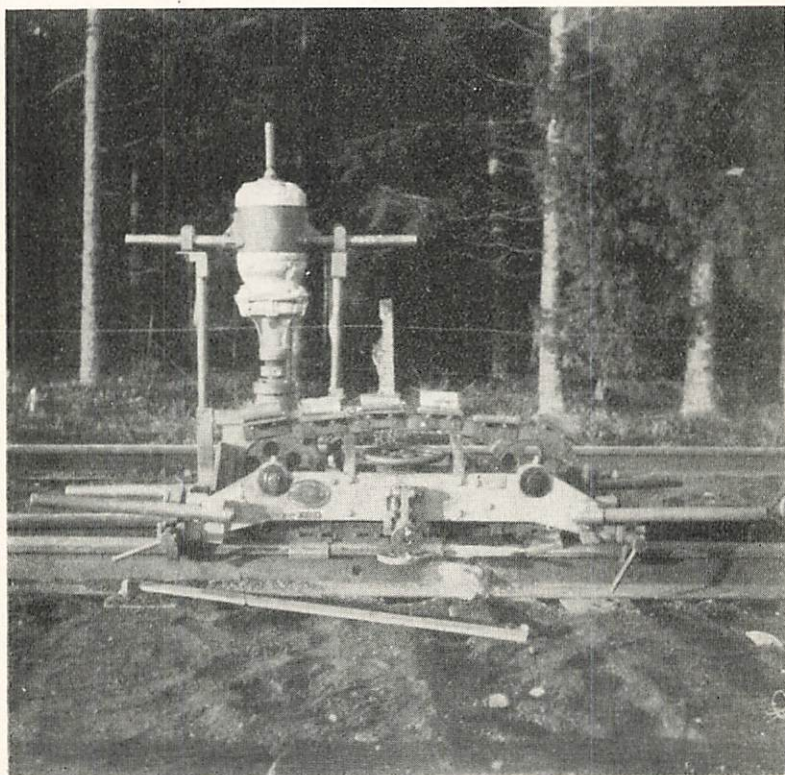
Raupenfeilmachine bearbetande en Thermitsvetsad skarv.
